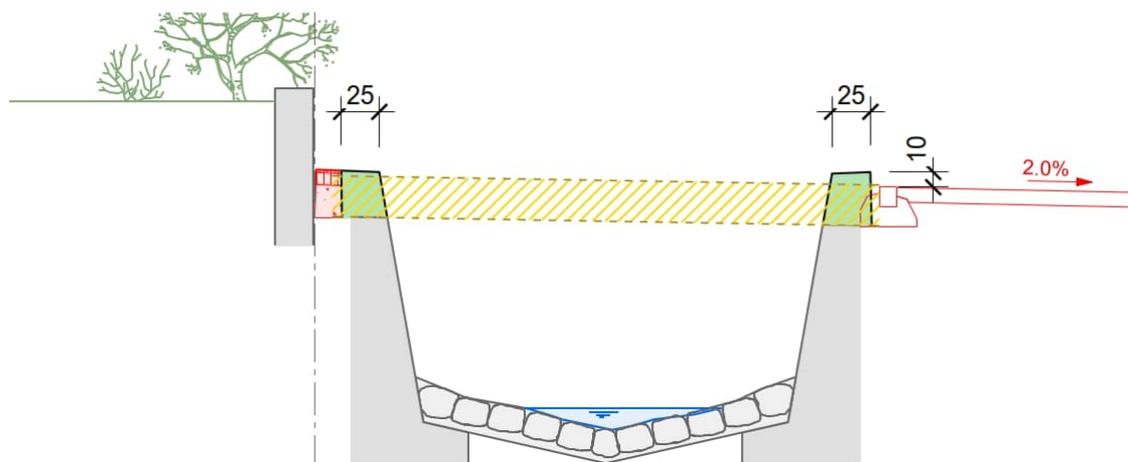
Bachöffnung entlang der Parz. 107 (vgl. Plan Nr. 2-1537.1 / 05)
